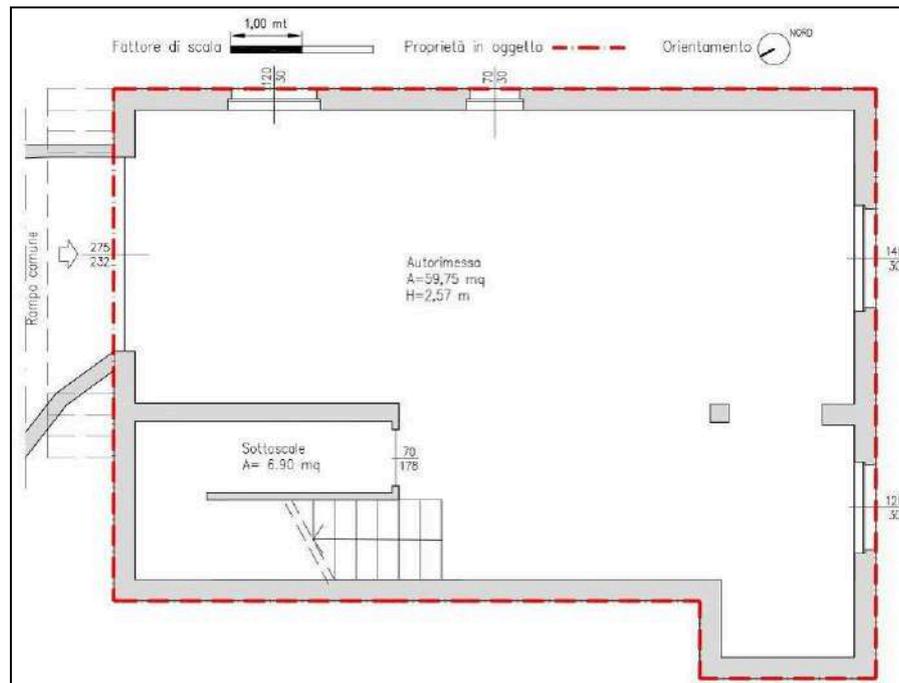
Pianta di rilievo dell'autorimessa piano seminterrato
